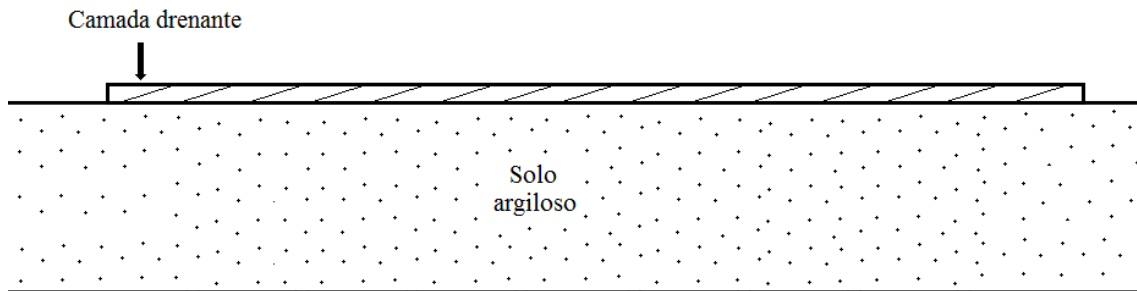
Esquema da aplicação da camada drenante na base do aterro
